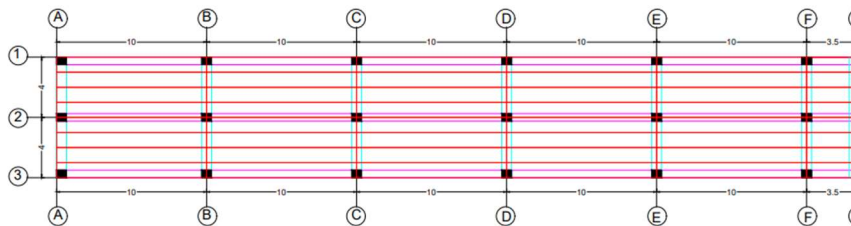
Plano de losa. 2023 imagen: Lucero Gómez
